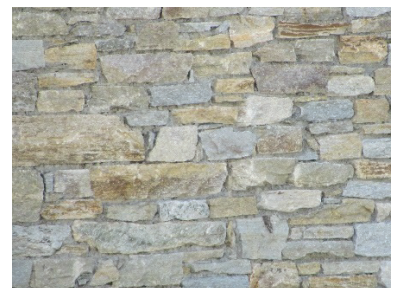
Exemples de façades en pierre ou parement de pierre préconisés
